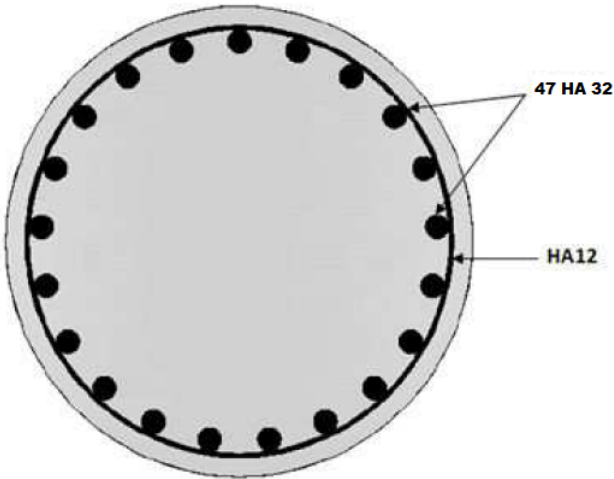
Ferrailage du pieu de la pile (coupe transversale)
